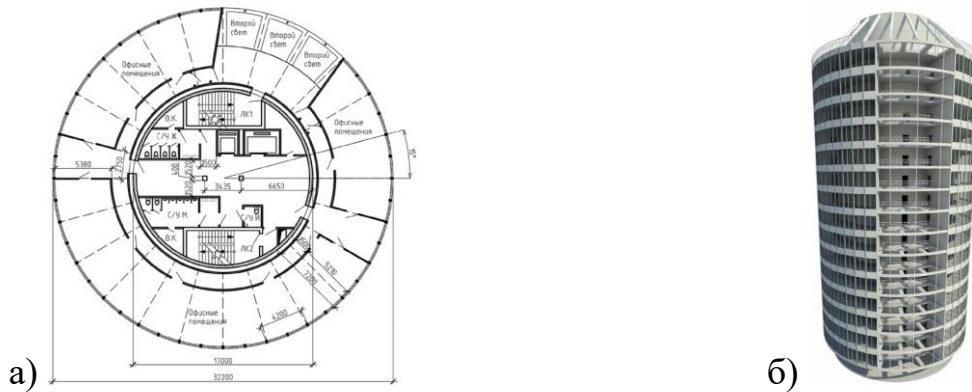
Здание с подвесными конструкциями: а) план типового этажа; б) визуализация здания
